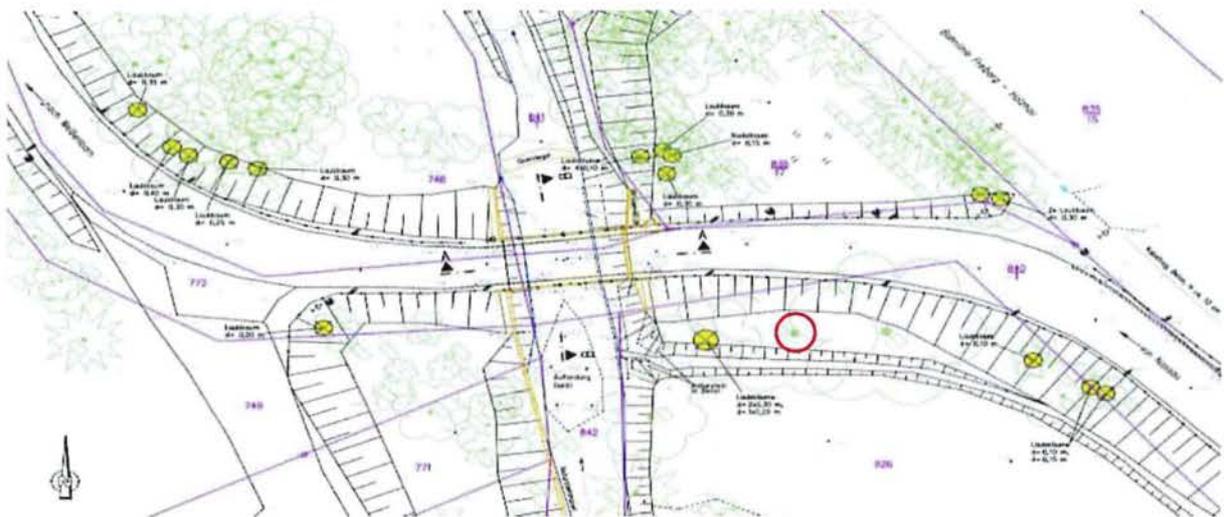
Höhlenbaum im Lage- und Höhenplan Bestand (IB Kühnel 30.11.2020)
